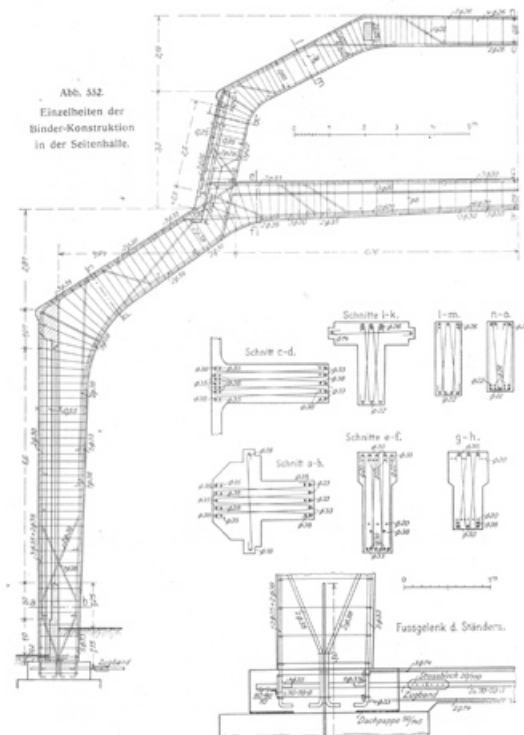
Bewehrungsplan (Büsing 1912, S. 709).
